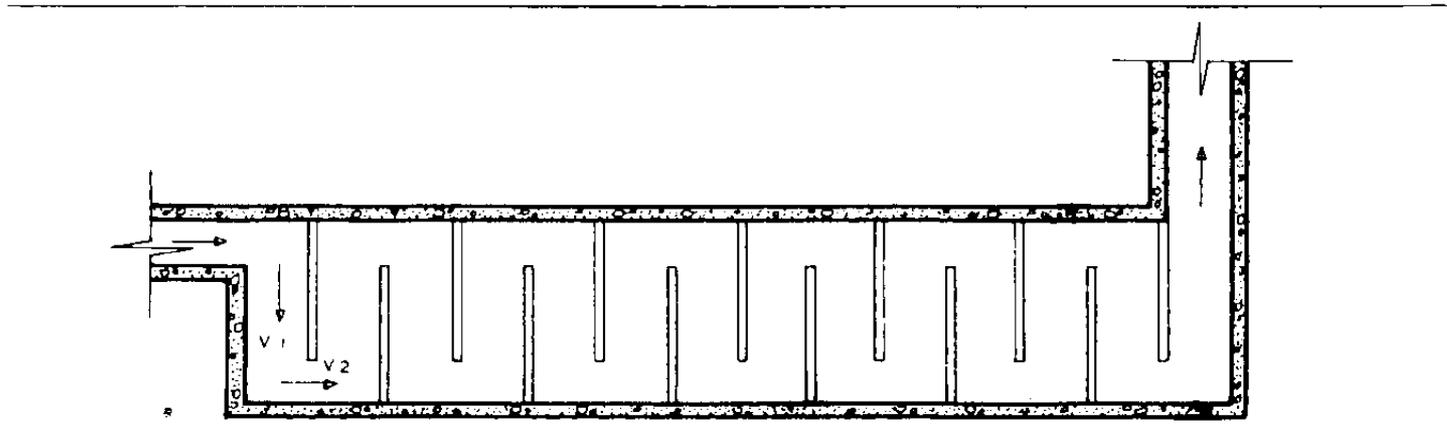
Câmara com chicanas de fluxo horizontal – planta.
